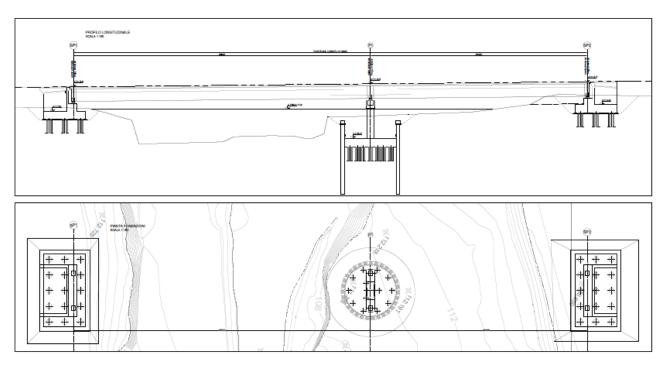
Profilo e pianta delle fondazioni del Ponte Chienti, comprensivi dell'opera provvisionale
